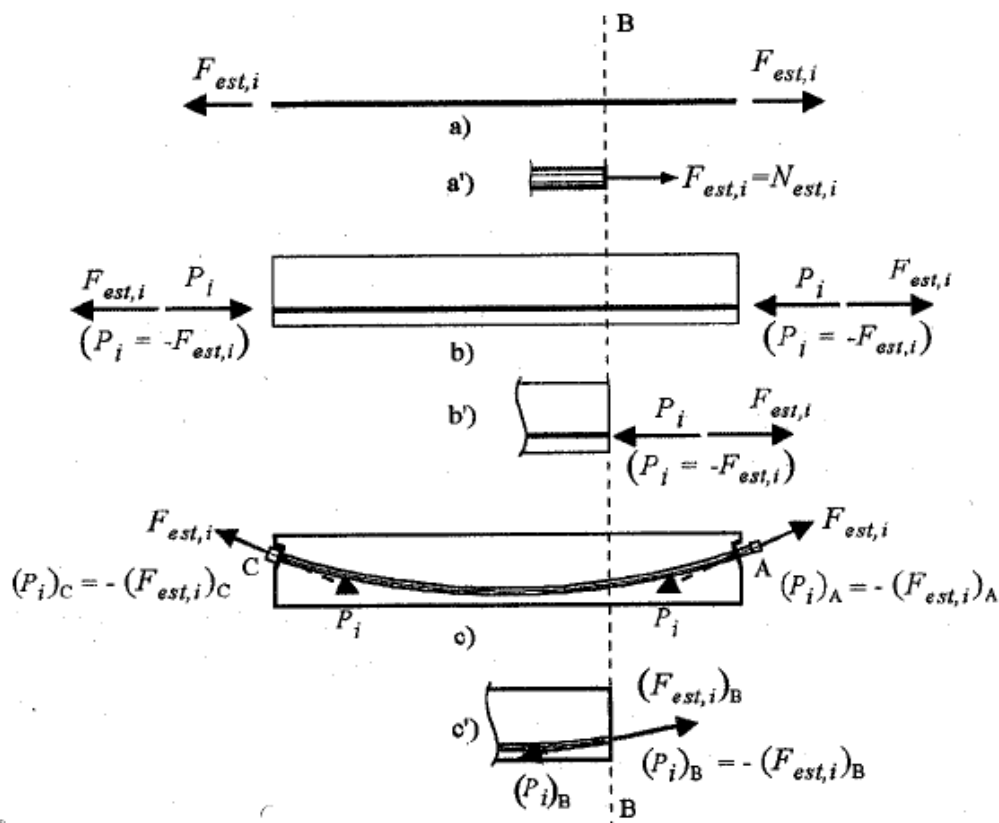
Esquemas de transmisión de esfuerzos en elementos pretensados. Pretensado con armadura pretesa: (a) Estiramiento previo de la armadura; (a') Esfuerzo de estiramiento sobre la sección izquierda B-B de la armadura; (b) Viga con armadura pretesa y fuerza de pretensado inicial (b') Esfuerzo actuante sobre la sección izquierda B-B de la viga. Pretensado con armadura postesa: (c) Transmisión del pretensado (fuerza de pretensado igual y opuesta a la fuerza de estiramiento).
